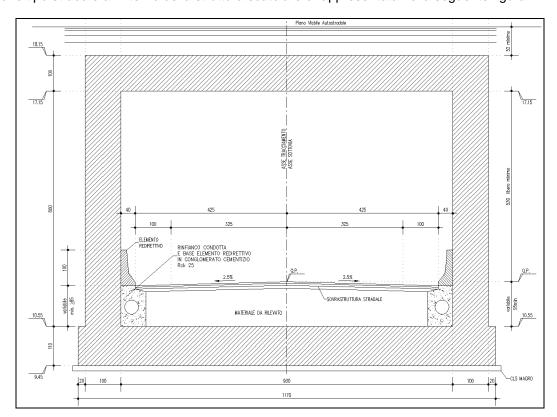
SEZIONE TRASVERSALE DEL SOTTOVIA
